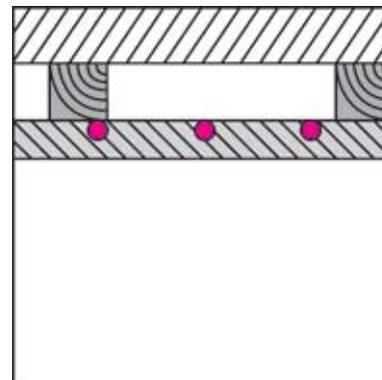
ND1 – Rohrsystem in Trockenbau-Platte – Decke
